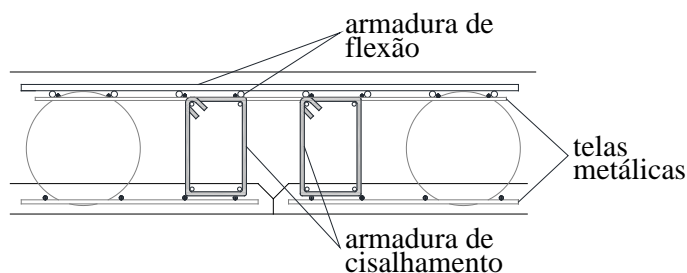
Posicionamento da armadura de cisalhamento, em corte, na laje.
